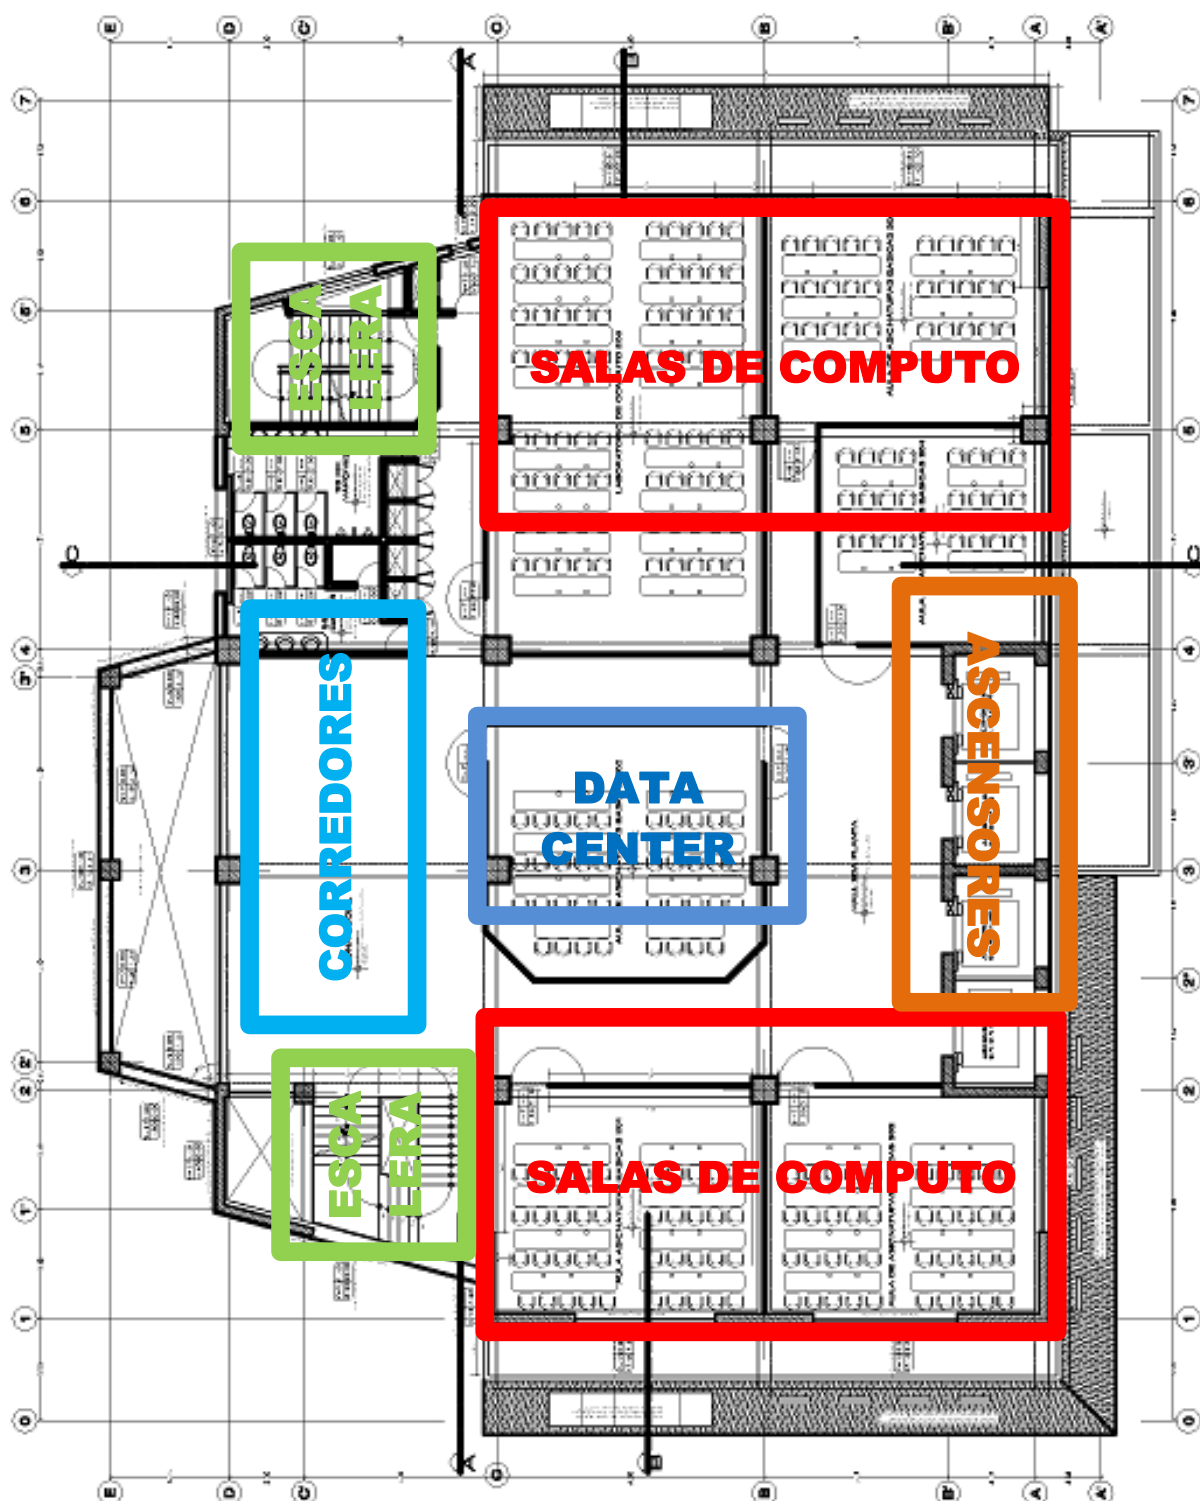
Distribución de zonas en planta típica<sup>42</sup>.
